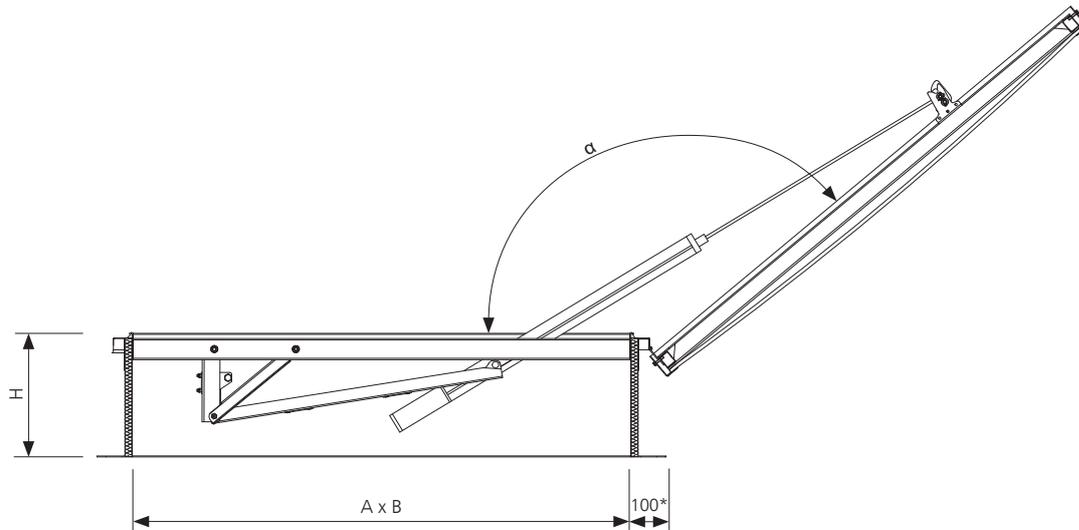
Vue en coupe B-B d'un lanterneau de désenfumage et d'accès toiture mcr PROLIGHT C/E ouvert, dimensions en mm
